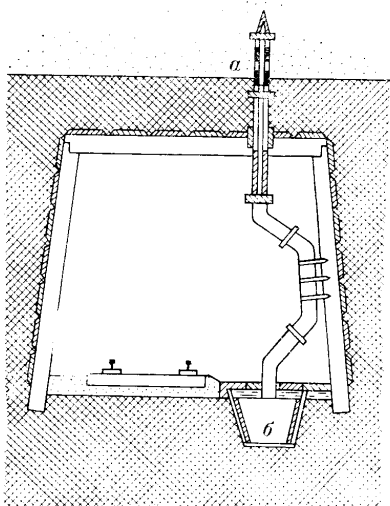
Схема осушения кровли угольного пласта забивными фильтрами
